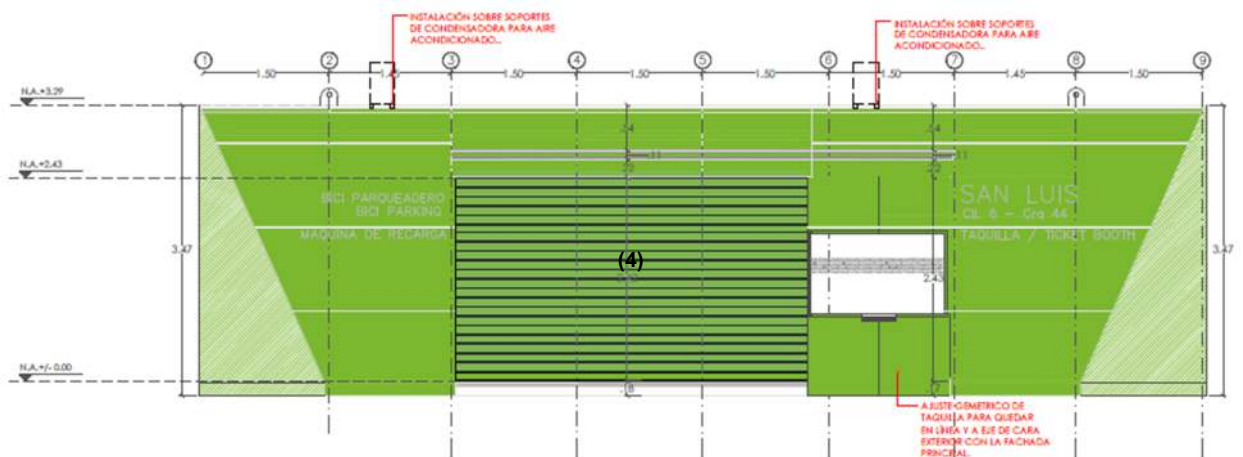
Puerta cortina en fachada principal Taquilla. Plano 8. A-201A FACHADA 1-2 cerrada 160819.dwg
